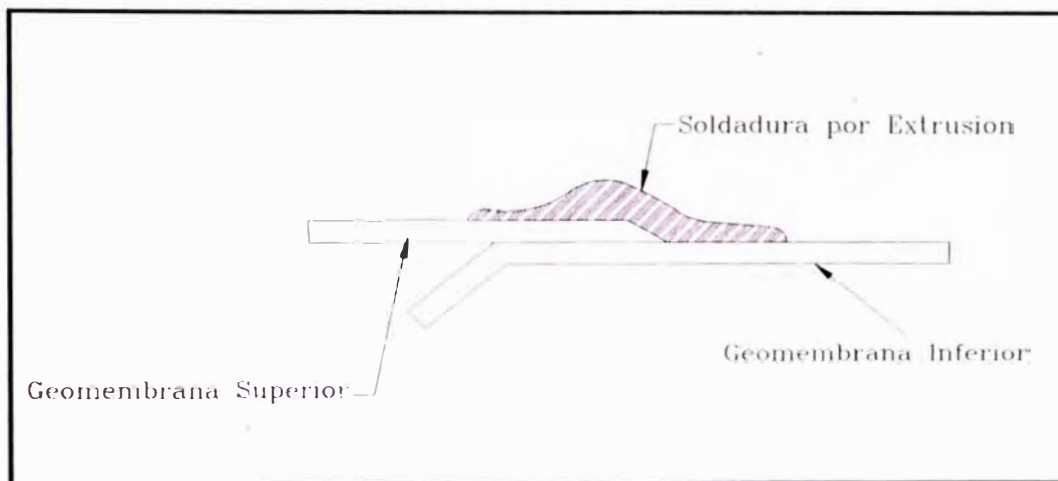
Detalle típico de soldadura por extrusión.
